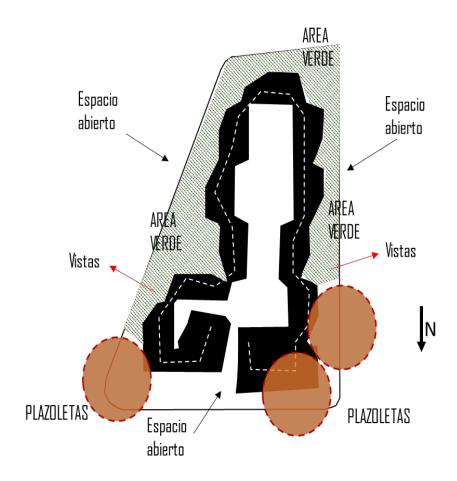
Emplazamiento en el terreno. (fuente: Mazzanti, 2008)
